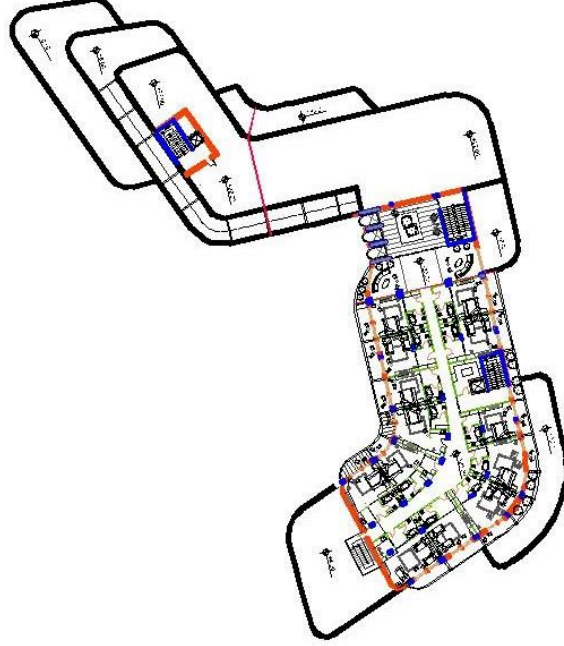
المسقط الأفقي للطابق الثاني.
